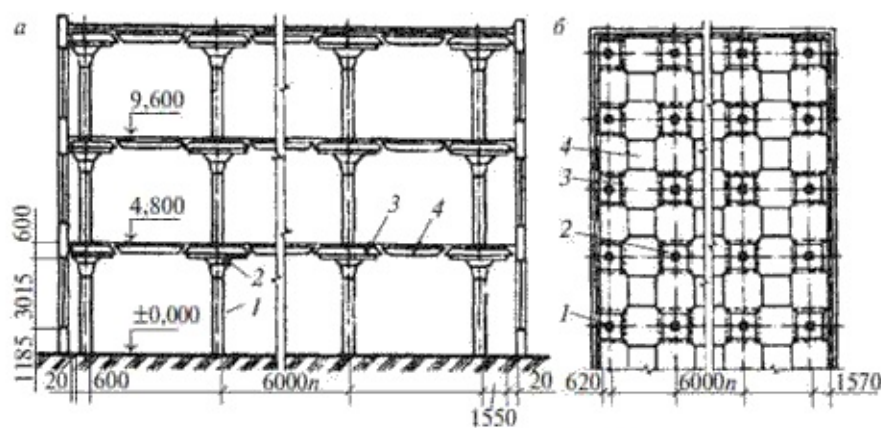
Многоэтажное сборное здание с безбалочными перекрытиями:
